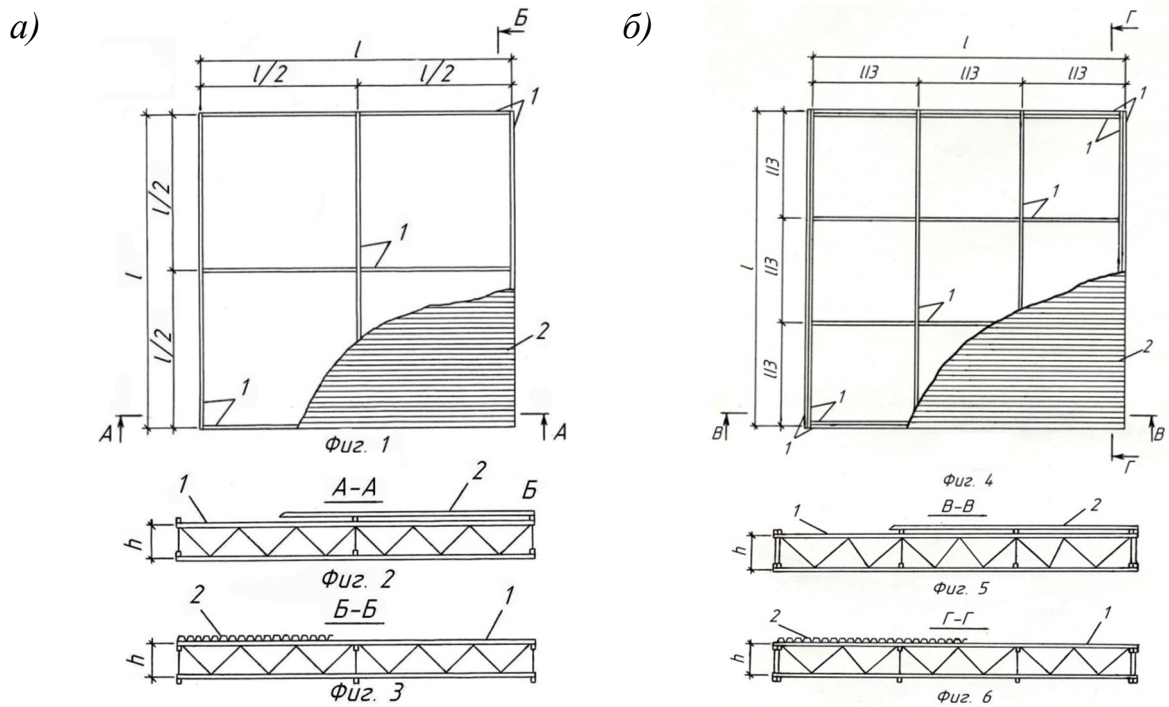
Схемы модуля «Пятигорск» из перекрестных ферм при количестве ячеек 2×2 (а) и 3×3 (б): 1 – одиночные перекрестные фермы; 2 – элементы ограждения (профилированные листы)
